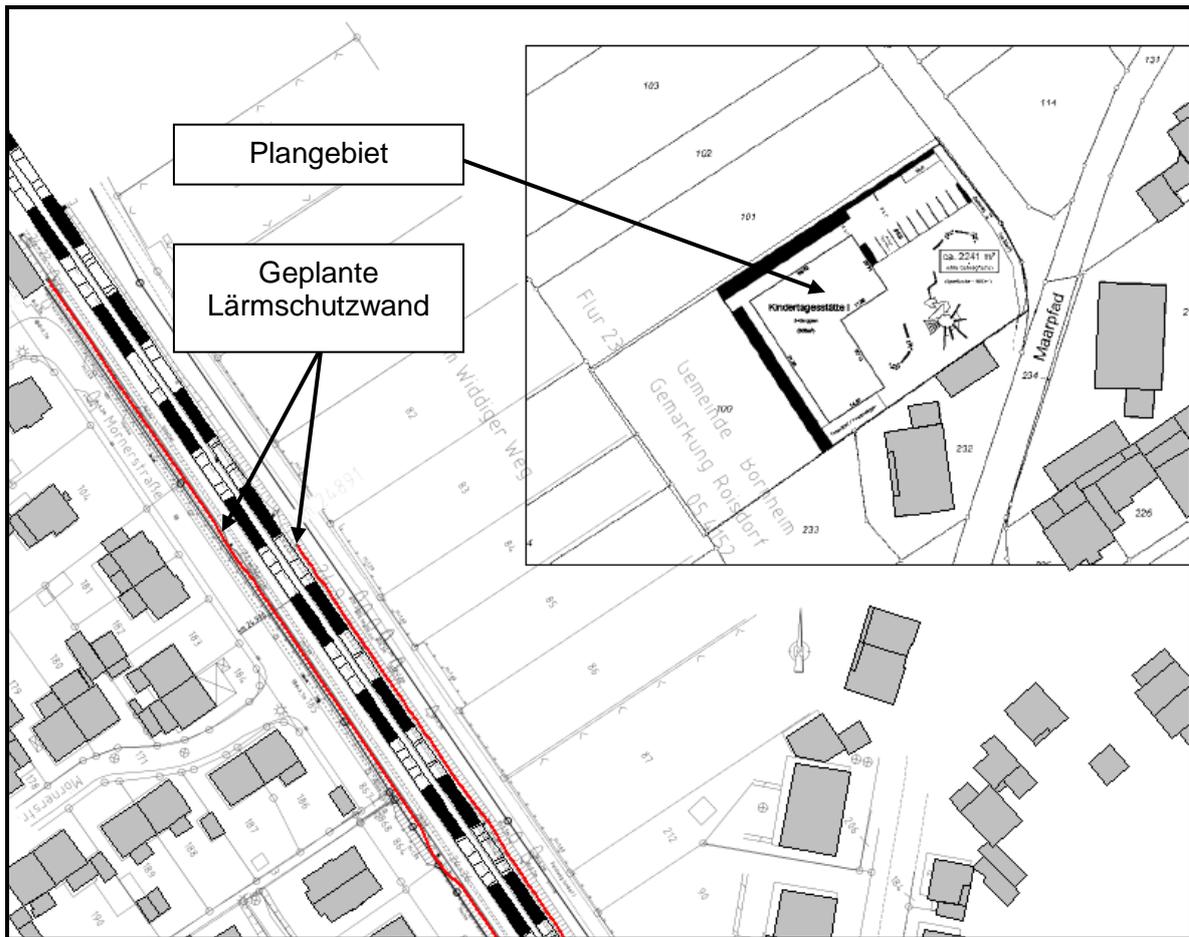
Lage des Plangebiets und Darstellung der geplanten Lärmschutzwand (rot)
